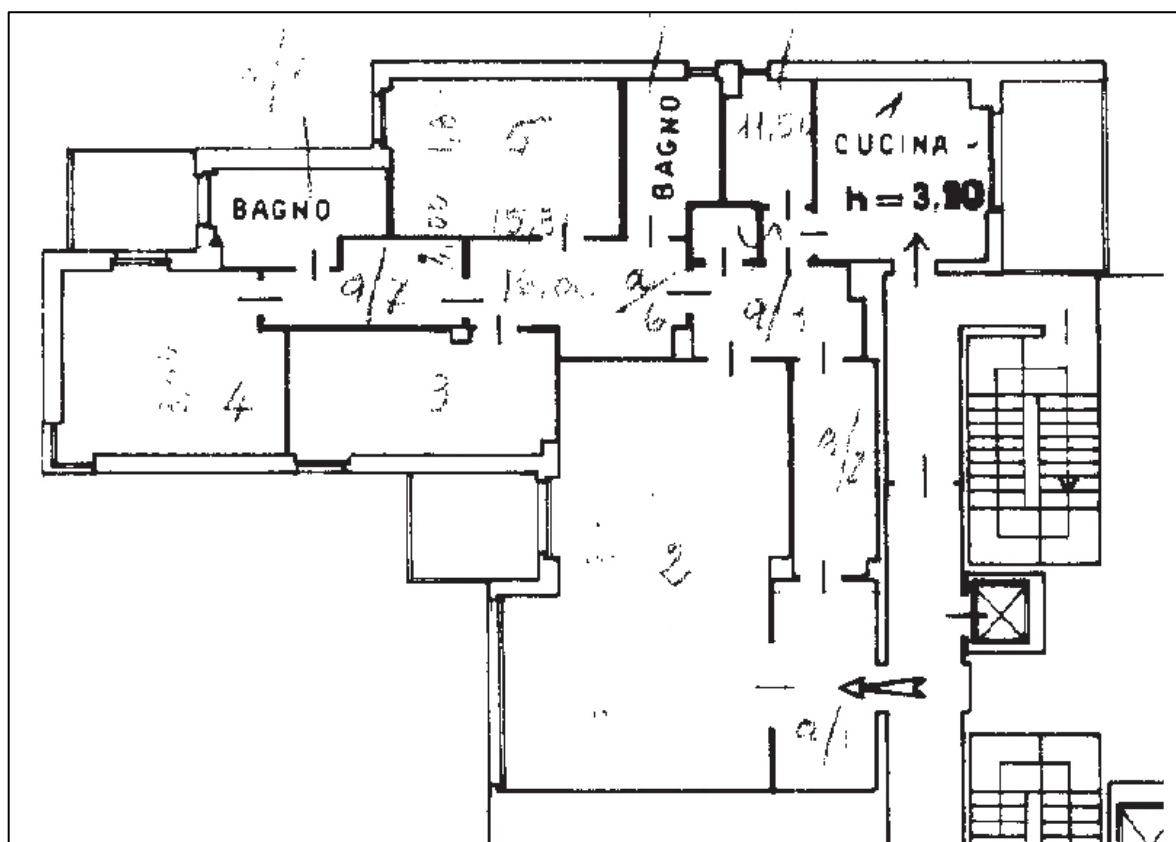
Planimetria catastale presentata il 11.03.1973
